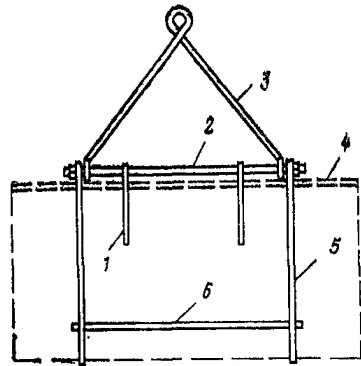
Захватное приспособление конструкции Н. М. Матвеева для подъема асбестоцементных листов
